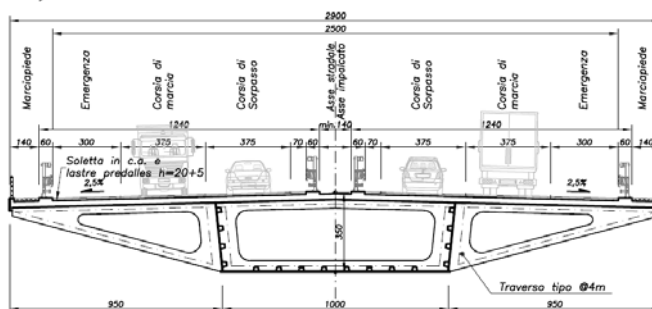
Sezione tipologica viadotto in mezzeria campata.
